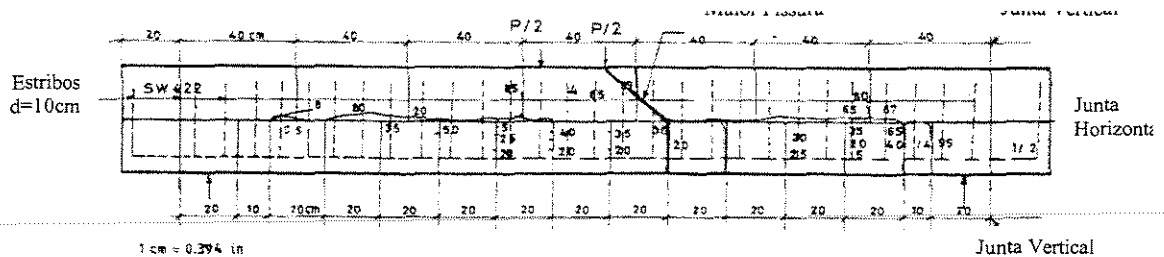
DIAGRAMA DE FISSURAÇÃO TÍPICA DE
